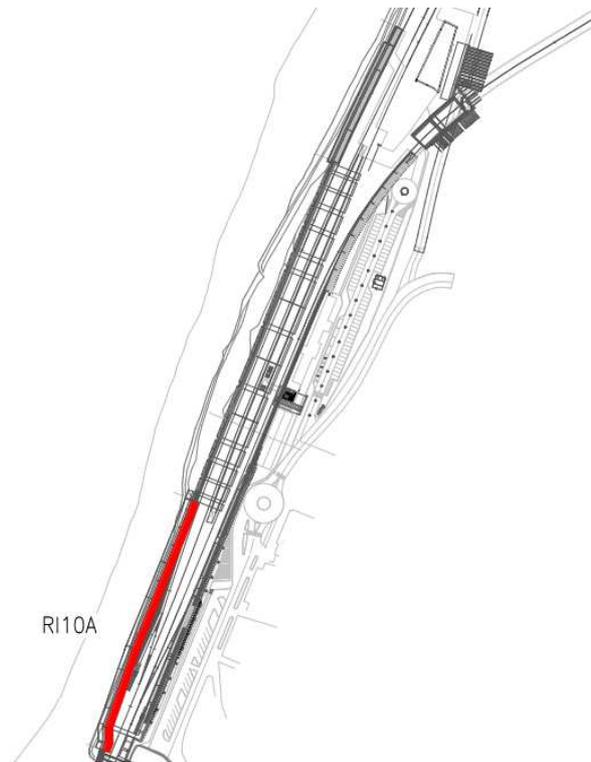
Planimetria e localizzazione dei muri di sponda presso la "zona muro 1".
